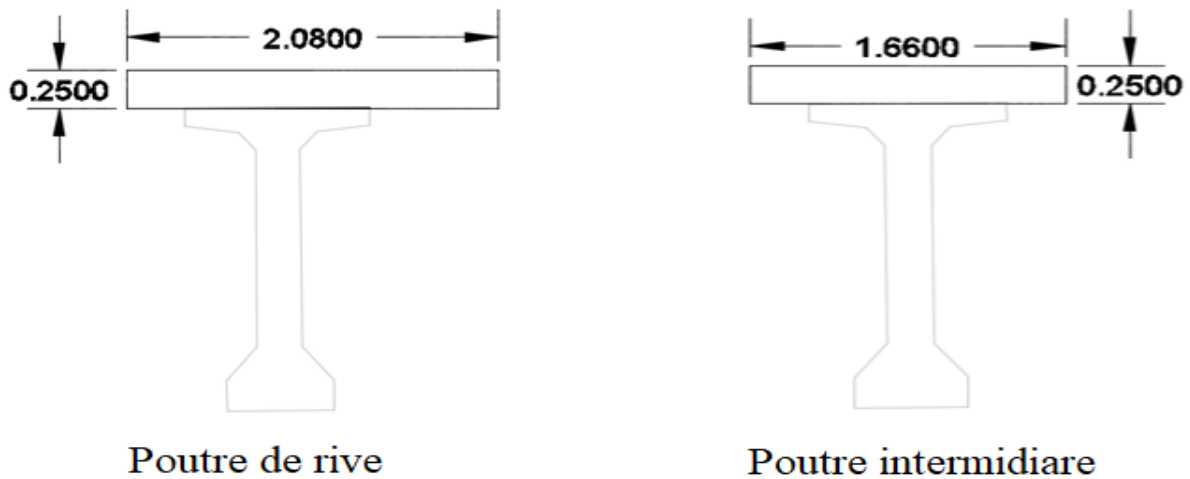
dimension de l'hourdie revenant aux poutres
